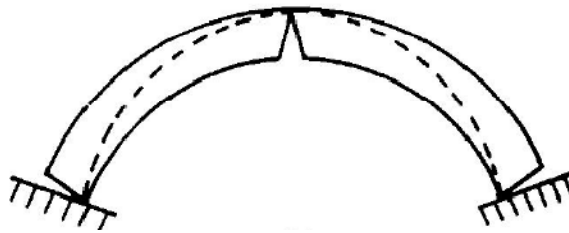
Estado de equilíbrio de um arco fissurado devido ao afastamento dos apoios.
